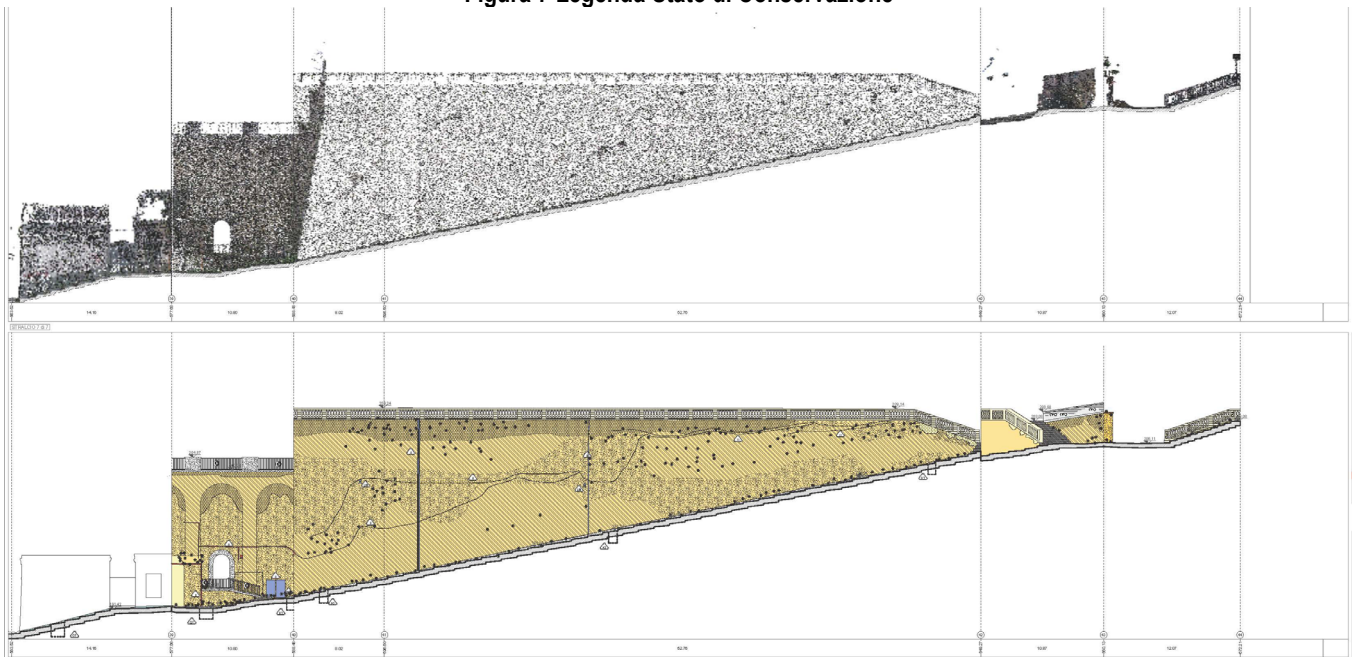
Stralcio elaborato Stato di Conservazione - serie CNAP001GKE- Scala della Pedamentina – Sezione longitudinale
